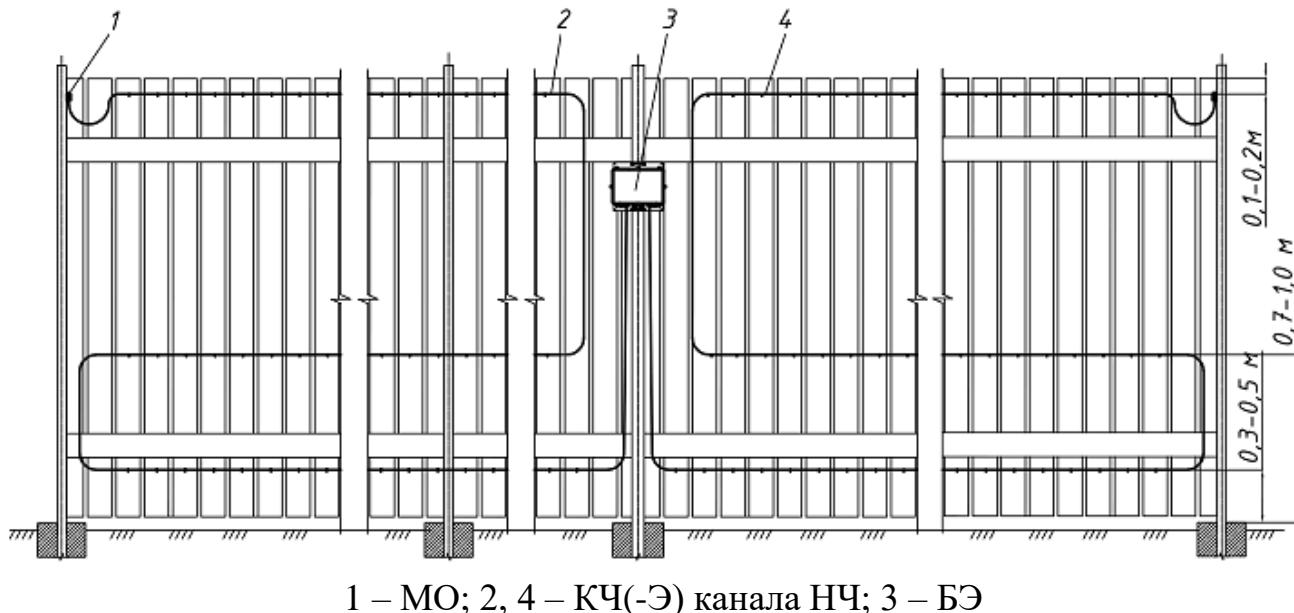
Схема монтажа КЧ(-Э) на заграждении из деревянных досок
